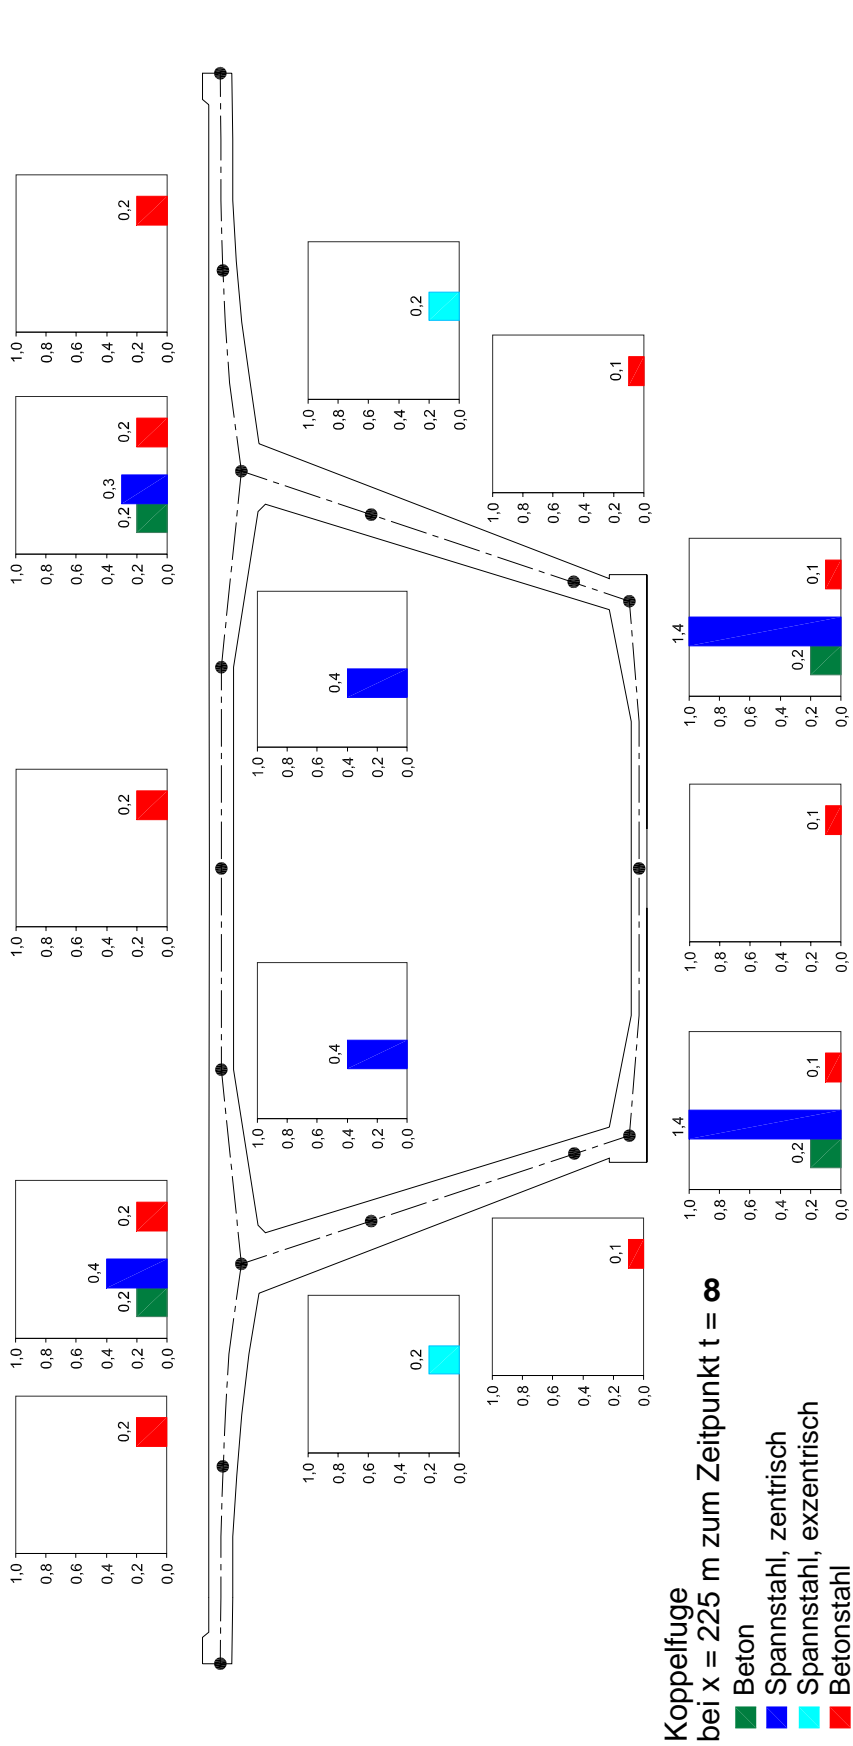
Ausnutzungsgrade des Betons δ_c , Spannstahls δ_p und Betonstahls δ_s
